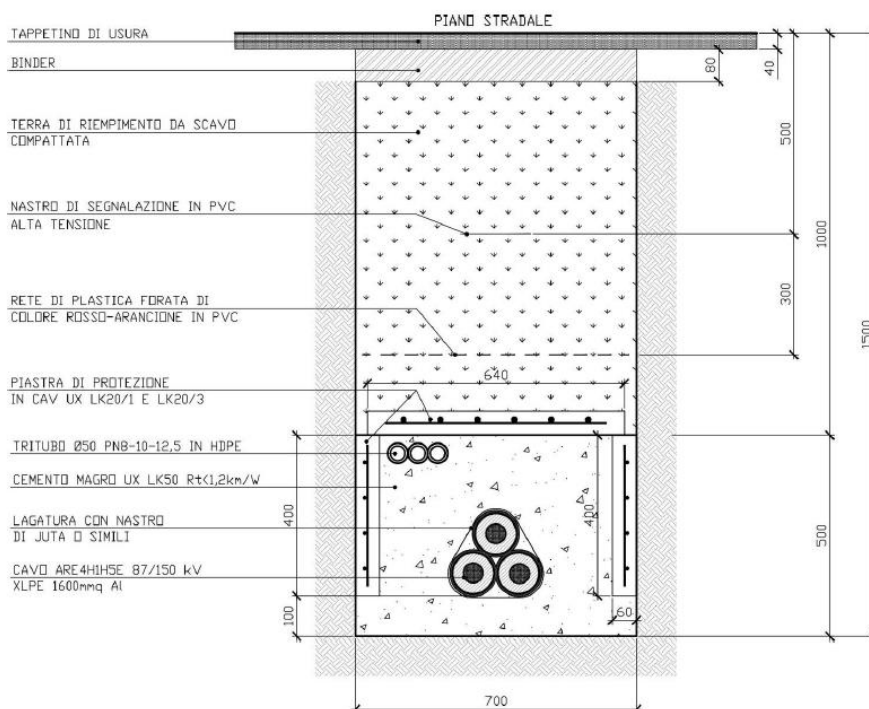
Sezione del cavidotto AT tipo sotto la strada
